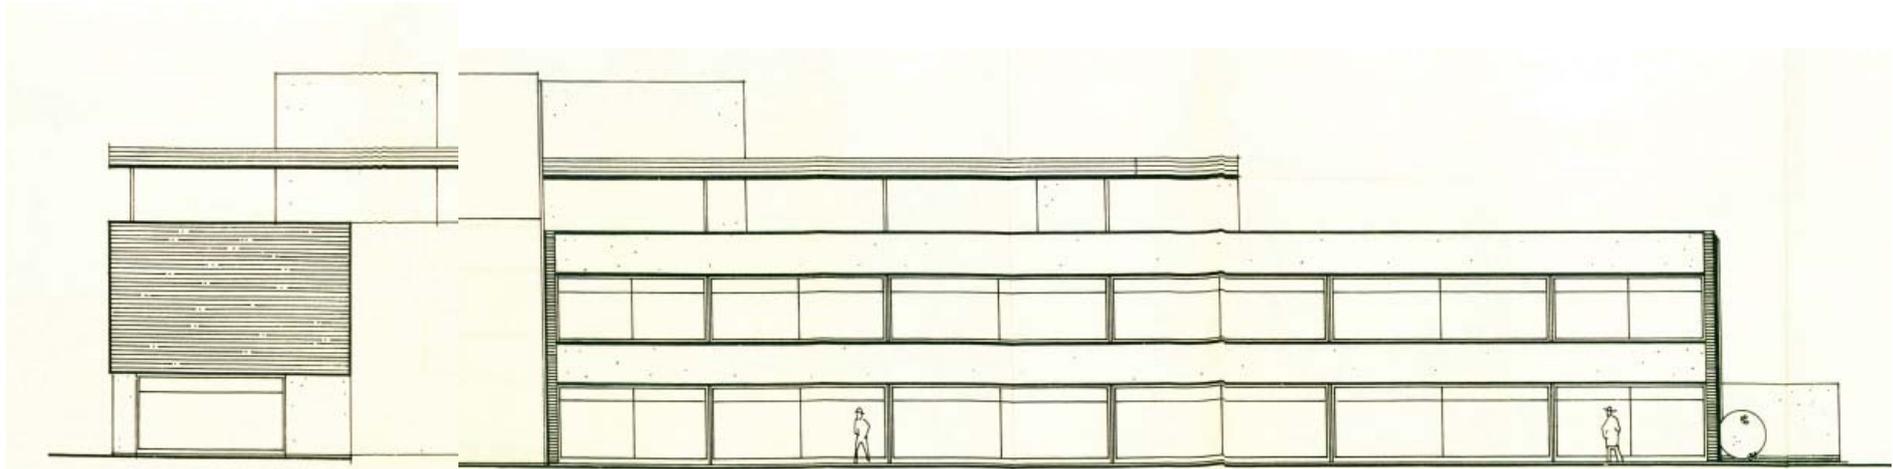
Einreichplan, Fassadendarstellung, Ost- und Südansicht, 5. Jänner 1968
